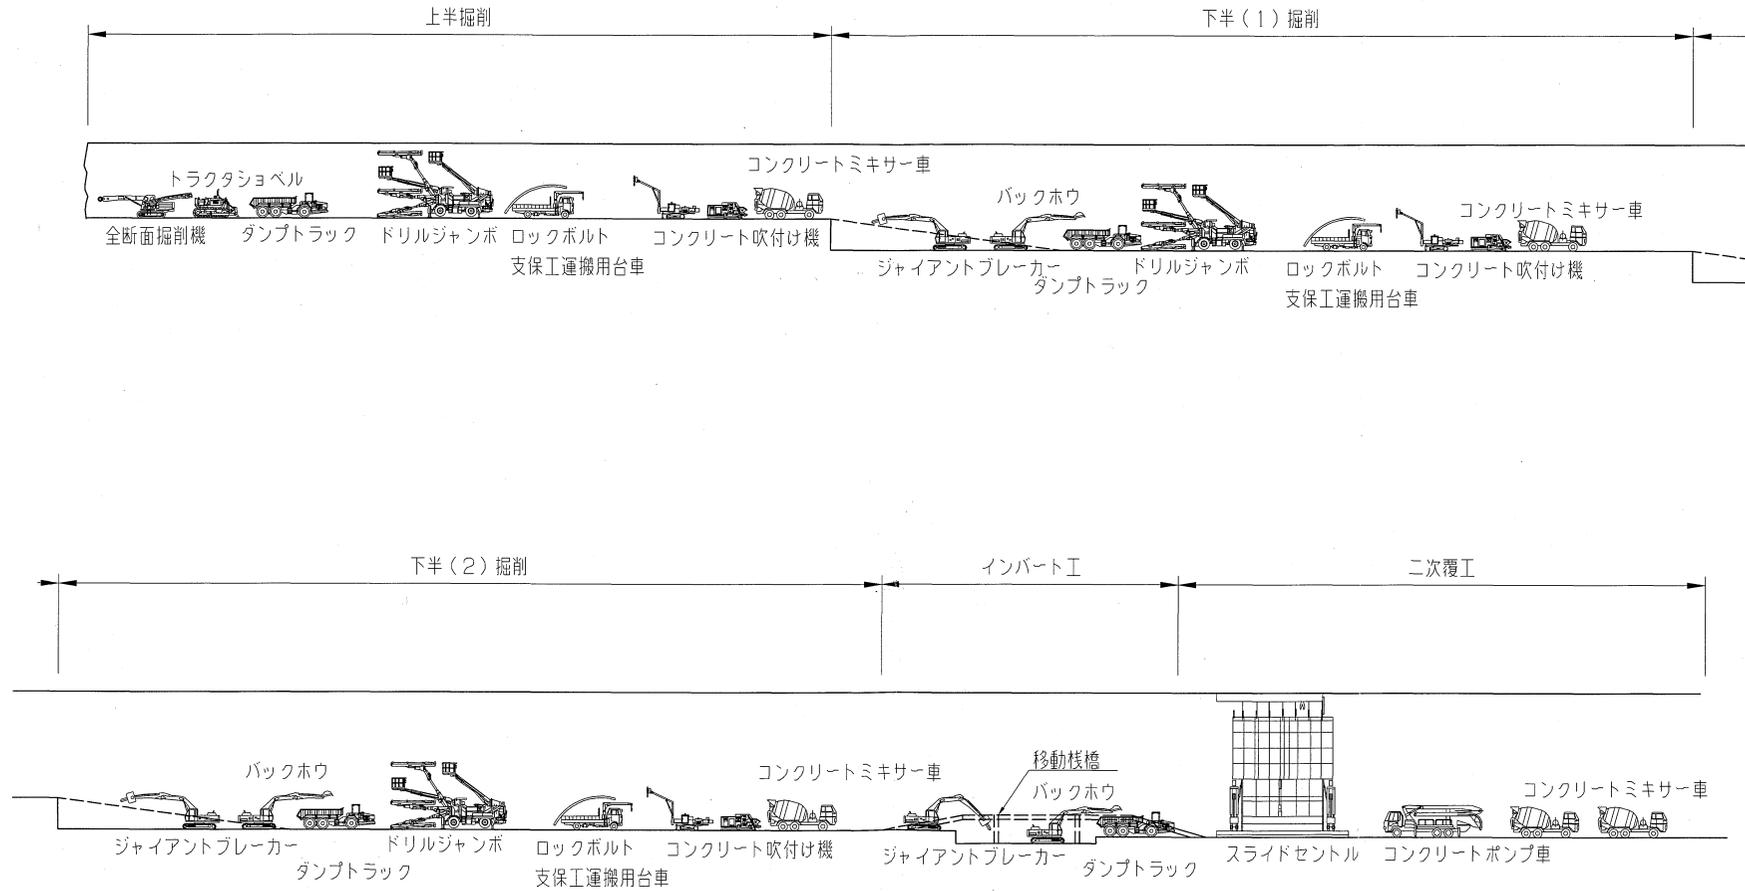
坑道掘削から二次覆工の施工までのイメージ図
